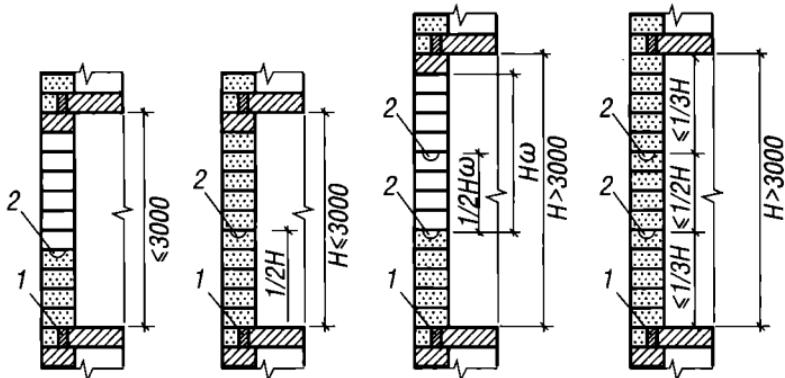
Схема армирования конструкции с высокими перекрытиями:
